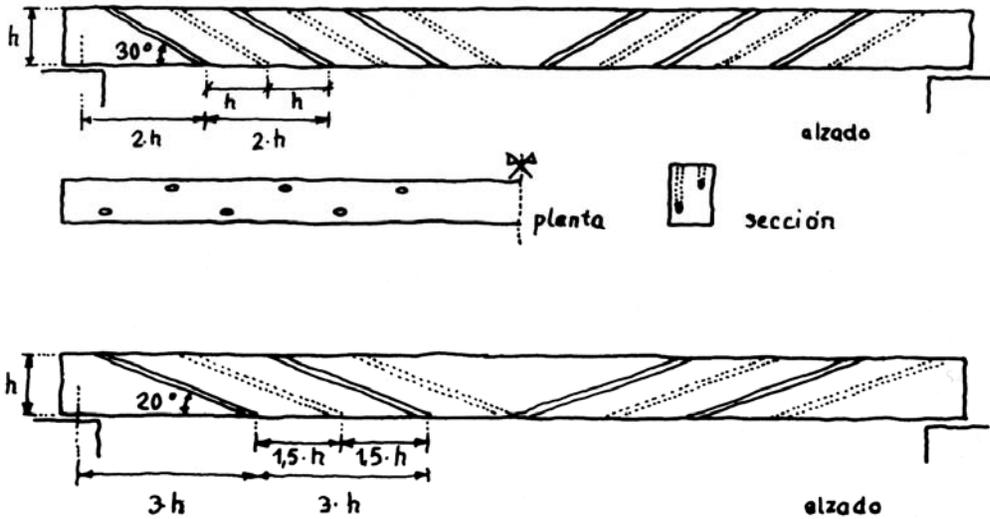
Refuerzo de vigas fendadas mediante una armadura interior.
